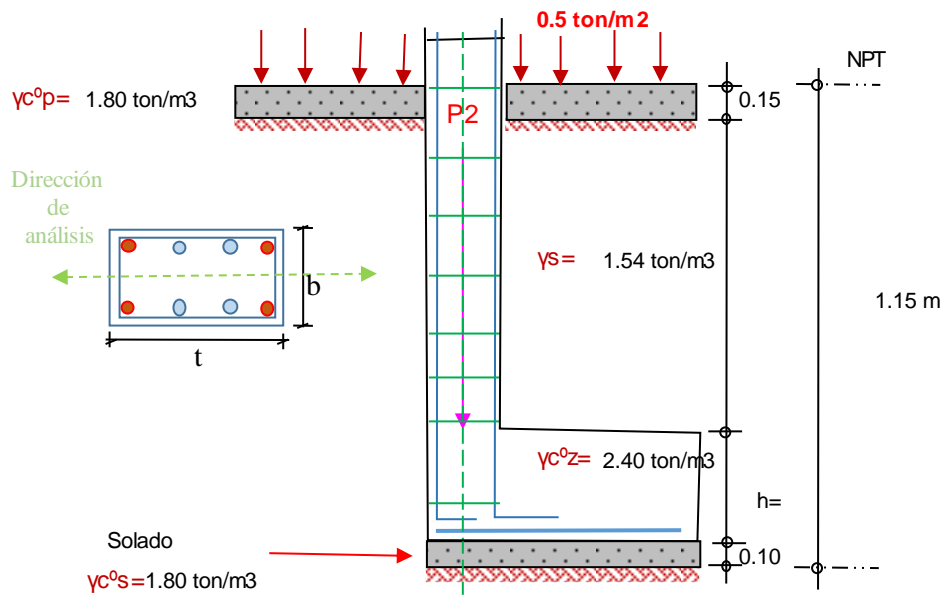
Detalle de zapata excéntrica (Estructura 1).
